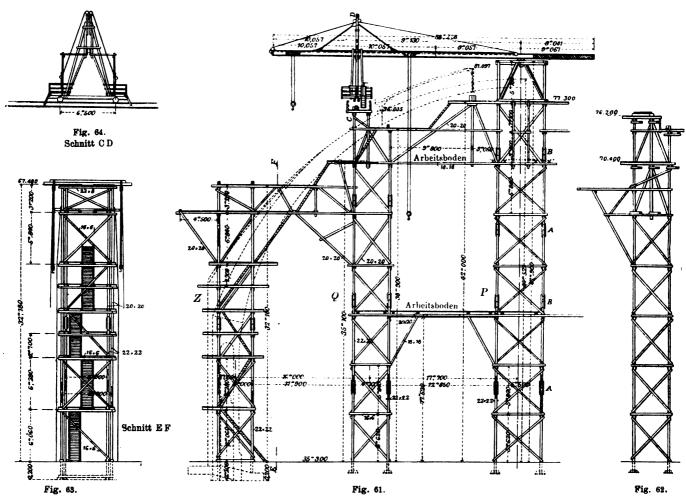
Gerüste für die Kuppelmontierung. Fig. 62. Querschnitt des Ringgerüstes Q. Fig. 63. Seitenansicht des Treppengerüstes Z. Fig. 64. Querschnitt des Kranes bei CD.
